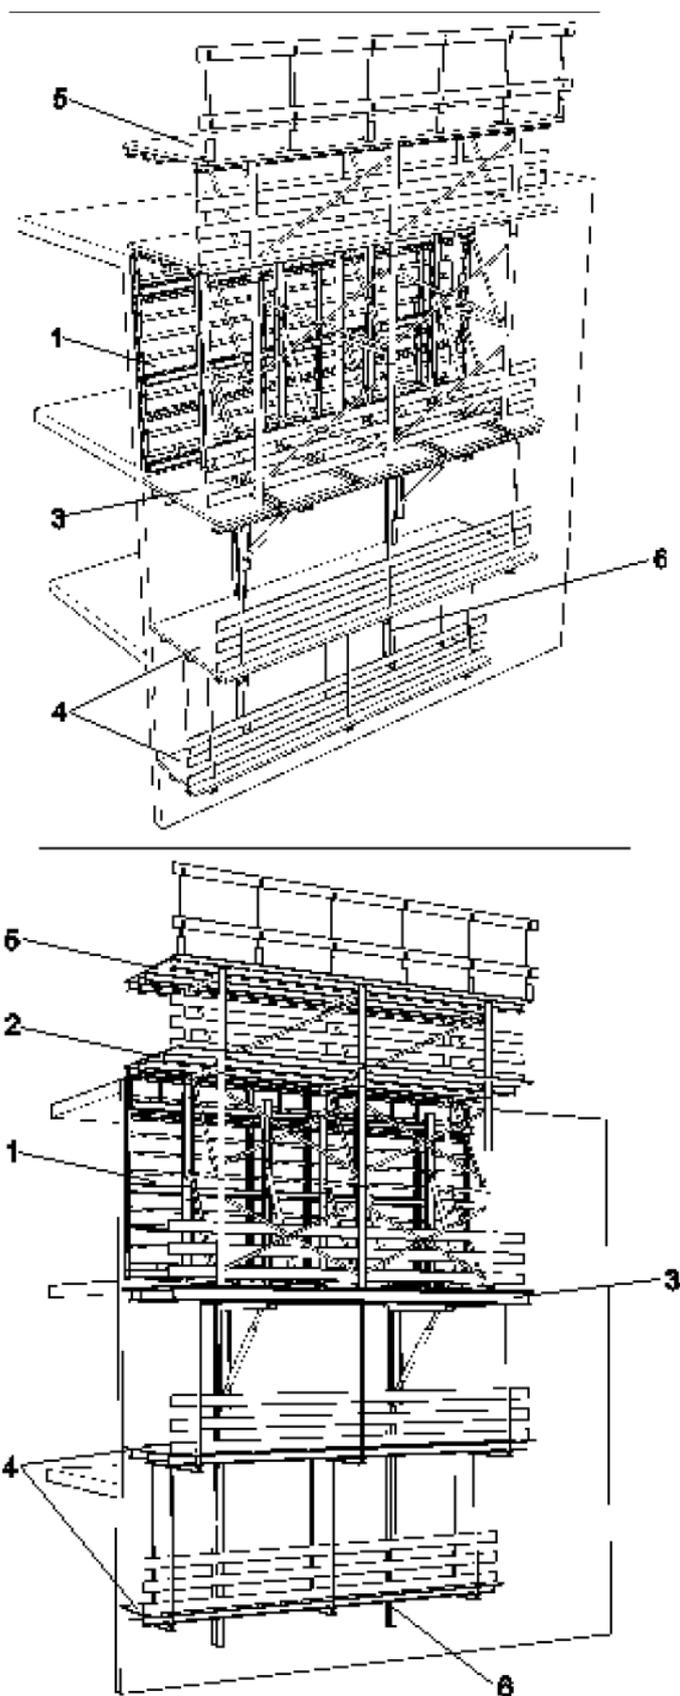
Схема устройства подъемно-переставной опалубки наружных стен с перемещением ее по направляющим балкам 1 – наружная опалубочная панель; 2 – навесные подмости для бетонирования; 3 – рабочие подмости; 4 – нижние подмости; 5 – подмости для армирования; 6 – направляющие балки
